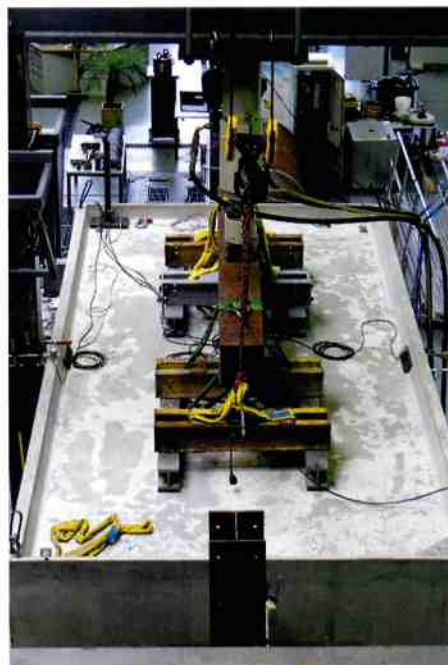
Bauteilversuche an Fertigteilgaragen aus Textilbeton
